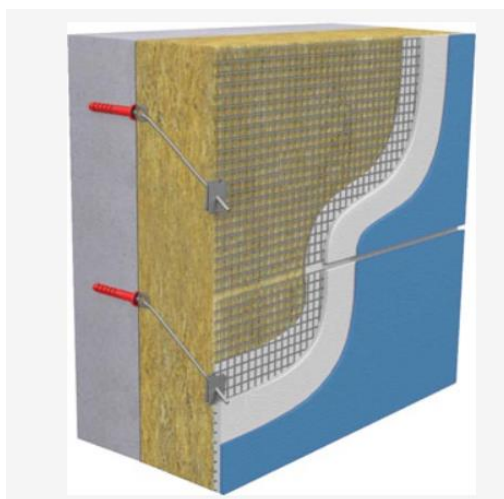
Розріз шарів утеплення зовнішніх фасадів будівлі [32]
